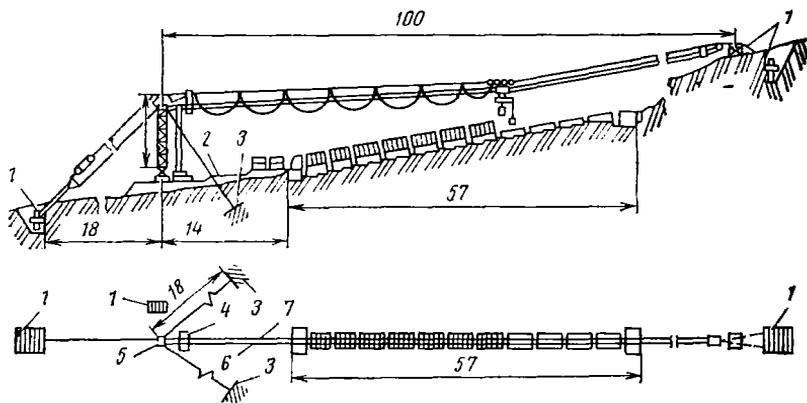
Монтажно-транспортная установка для сборки железобетонных труб на косогоре:
